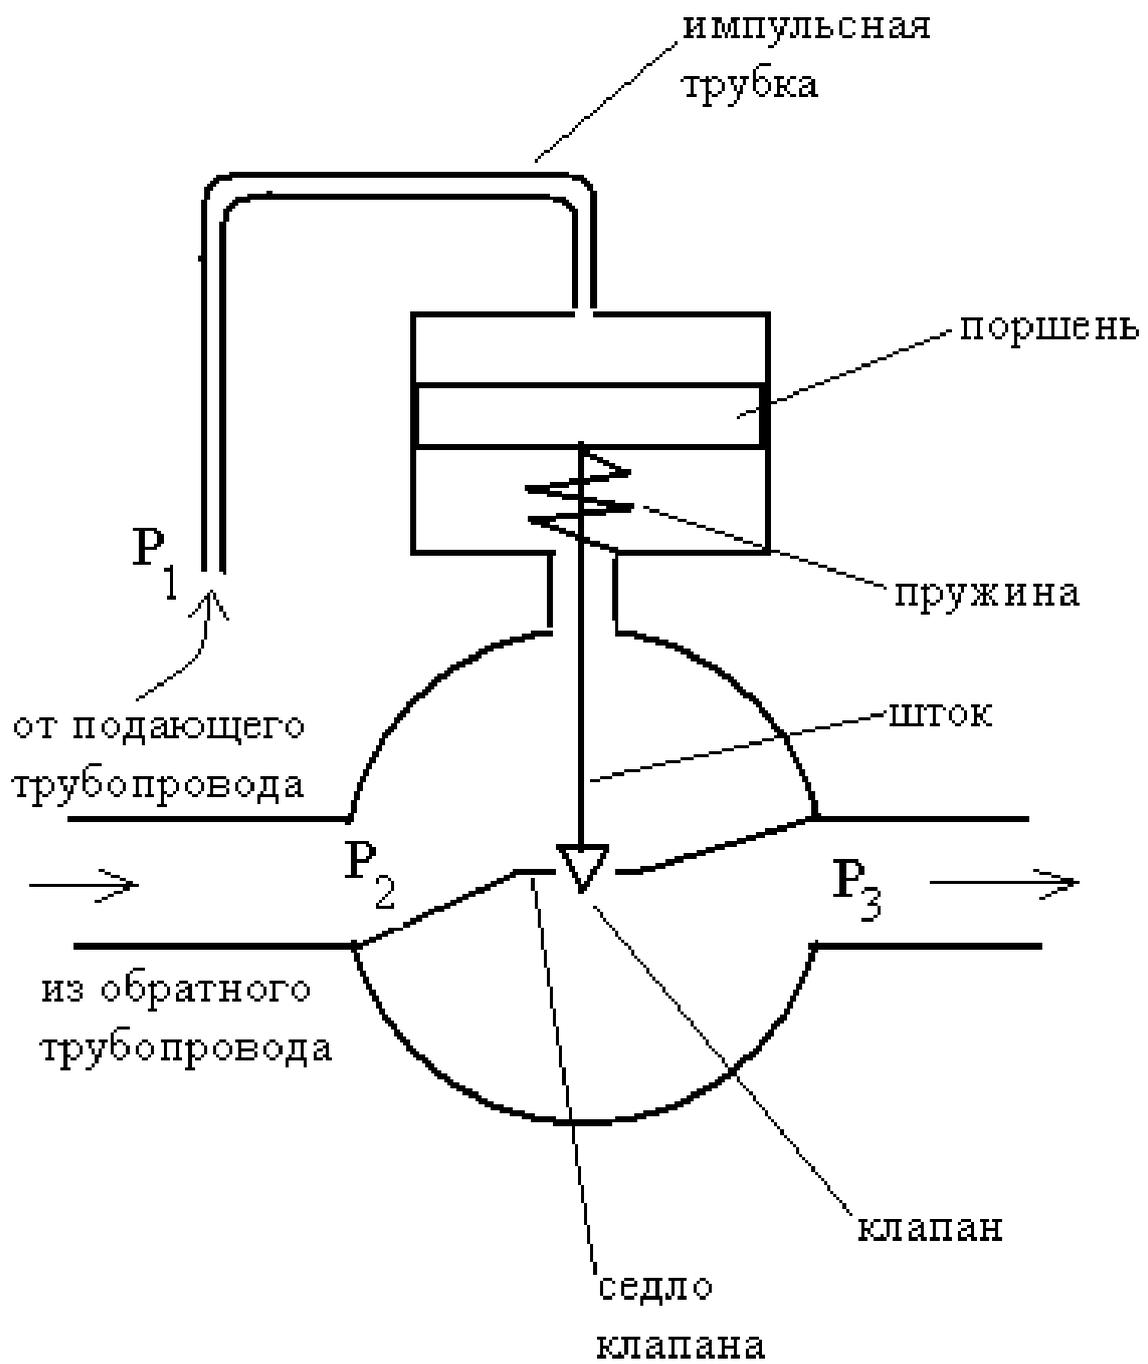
Принципиальная схема конструкции балансировочного клапана для системы водяного отопления
